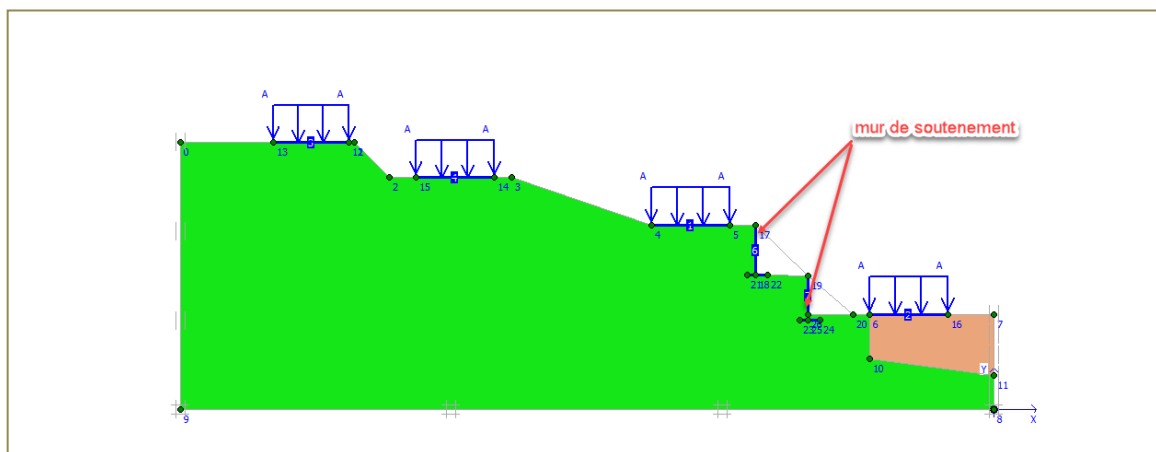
Stabilisation avec reprofilage + mur de soutènement.
